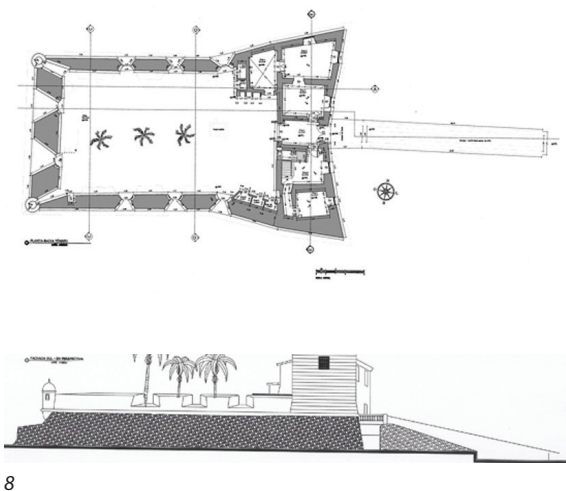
Planta e elevação do Forte de Santa Maria. Levantamento cadastral recente. Fonte: Projeto de restauro.
